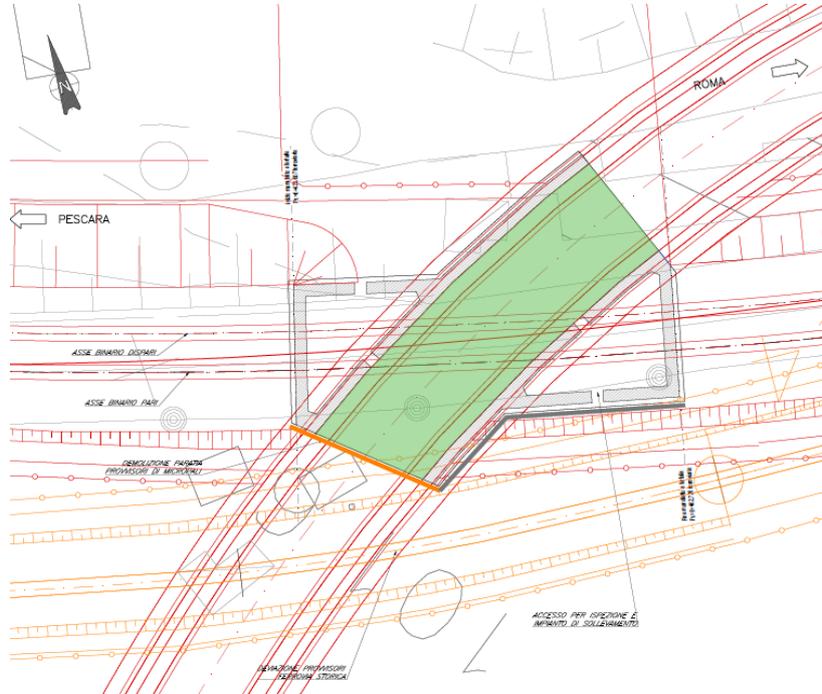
SL25 – Fase realizzativa 3, pianta sottopasso
